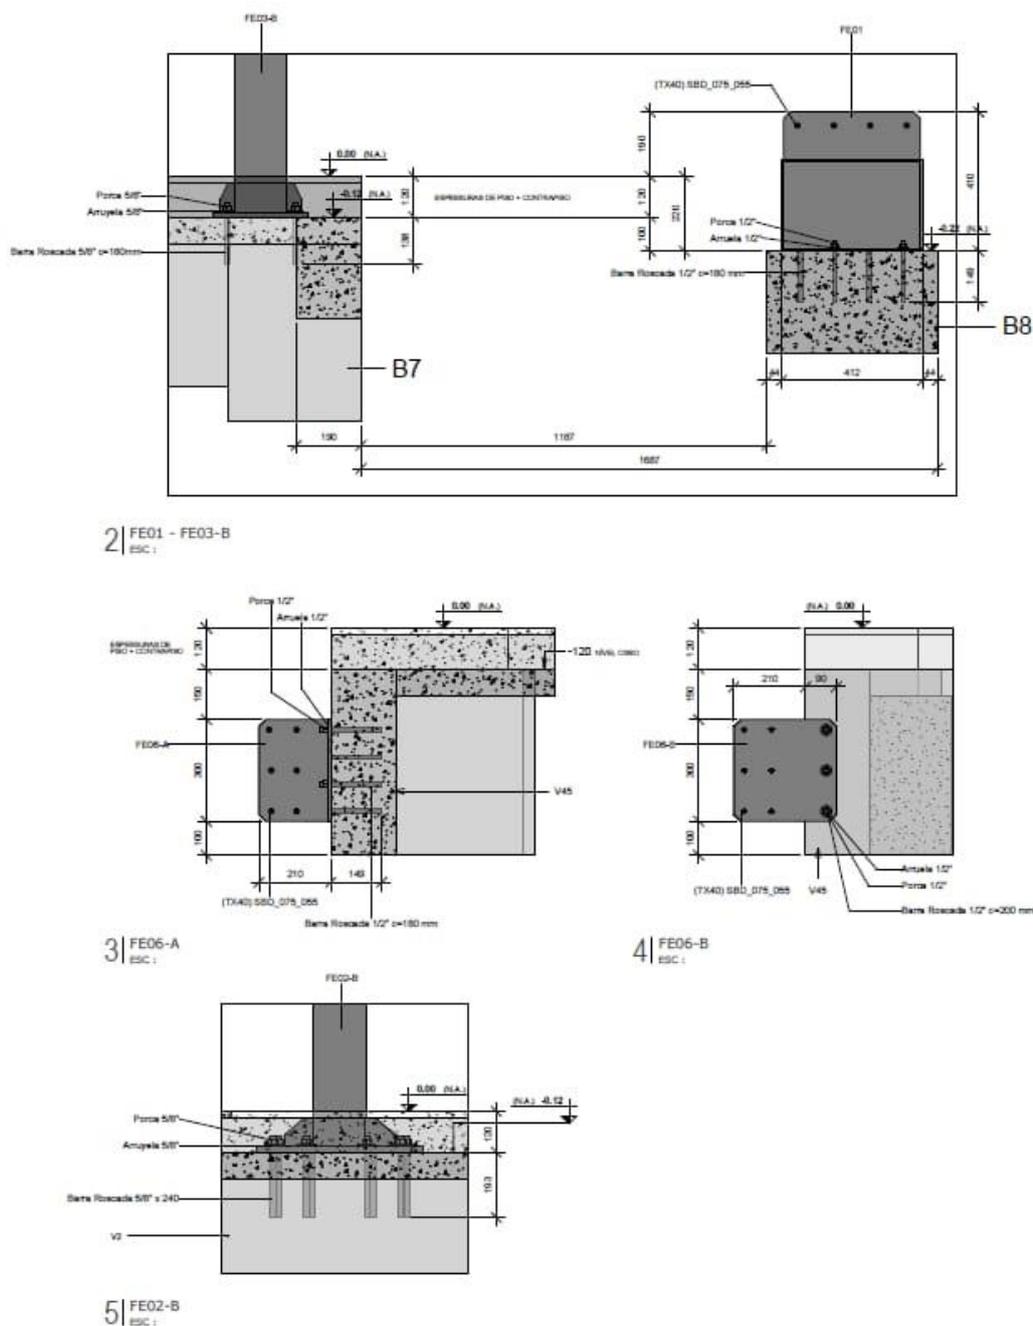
Projeto estrutural de *Wood Frame* da Construtora Gaucho.
